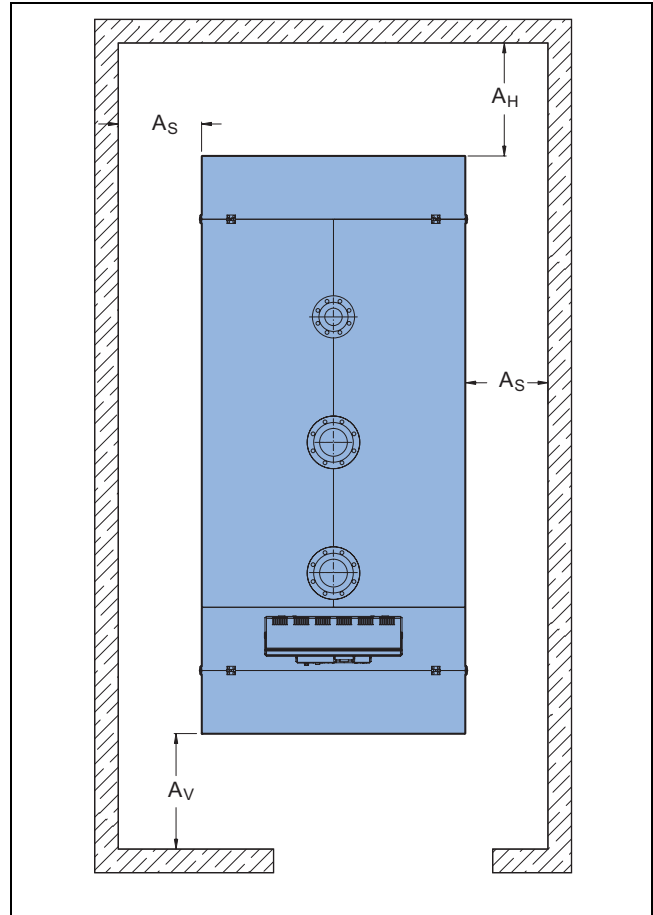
Local da instalação com caldeira de aquecimento, dimensões em mm
